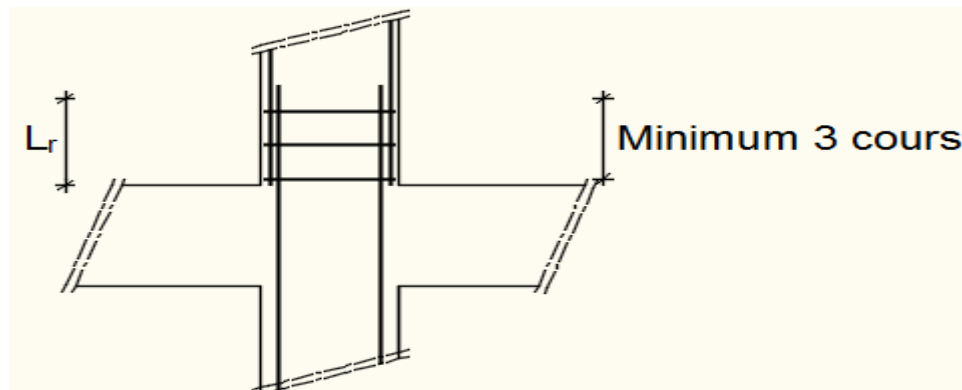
Les armatures transversales dans la zone de recouvrement.
